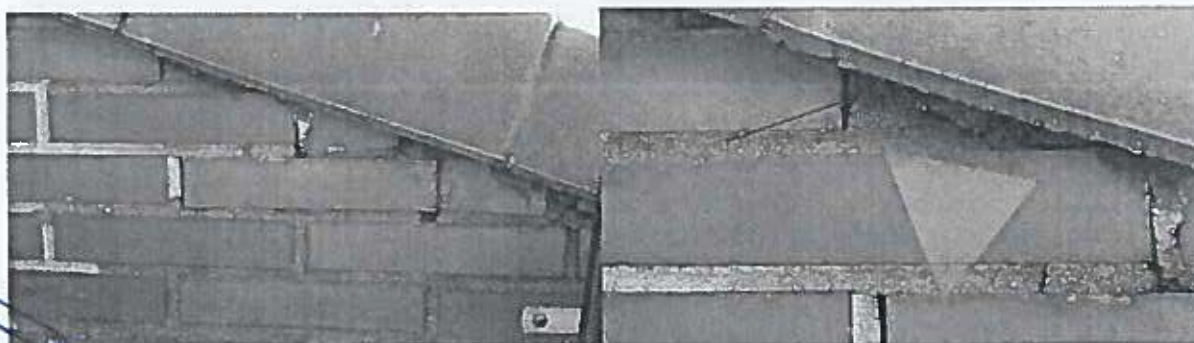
Se detecta humedad bajo las piezas singulares que protegen el límite de la cubierta.
